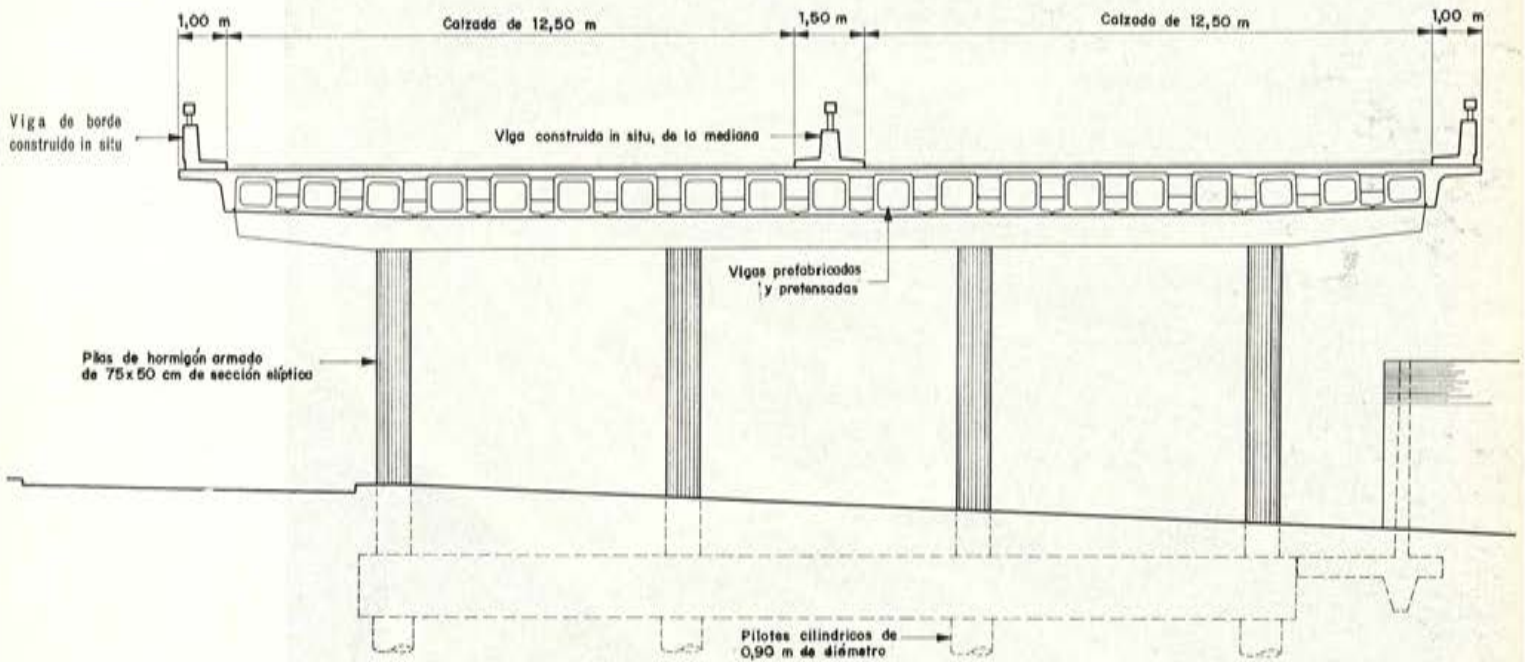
Paso elevado de Westway, en Londres. Sección transversal del tramo de 22 m de luz en el cruce de Ladbroke Grove.
